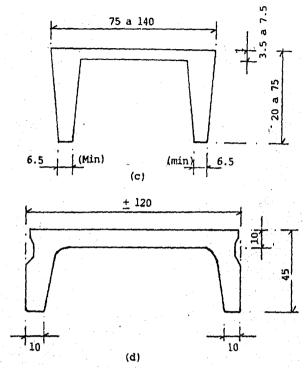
Secciones de concreto postensado que comúnmente se utilizan en edificaciones.
